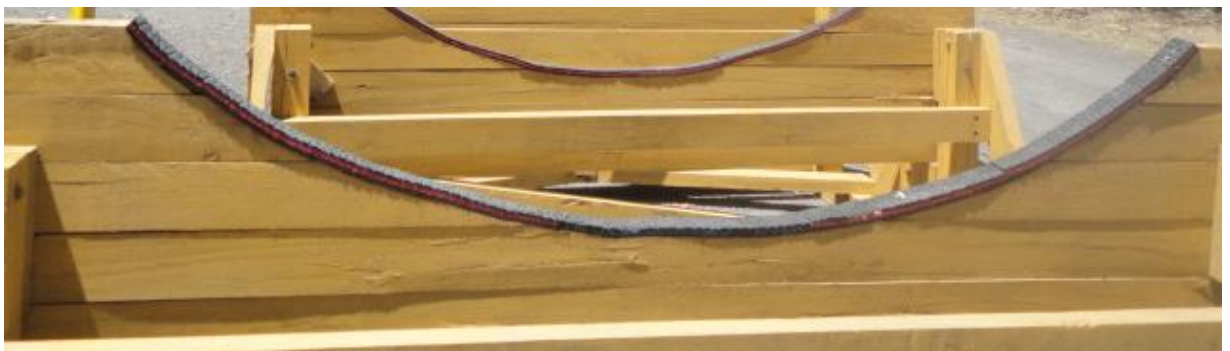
Diseño del tablero del soporte tipo caballete
